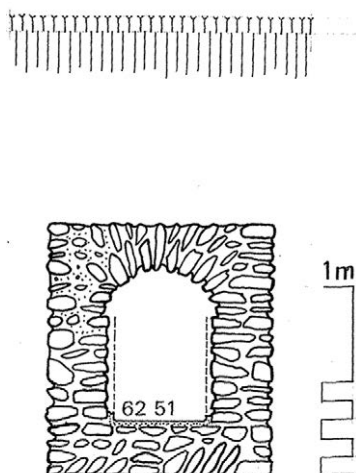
Coupe sur le canal d'arrivée des eaux pluviales du forum (G. Hallier).
